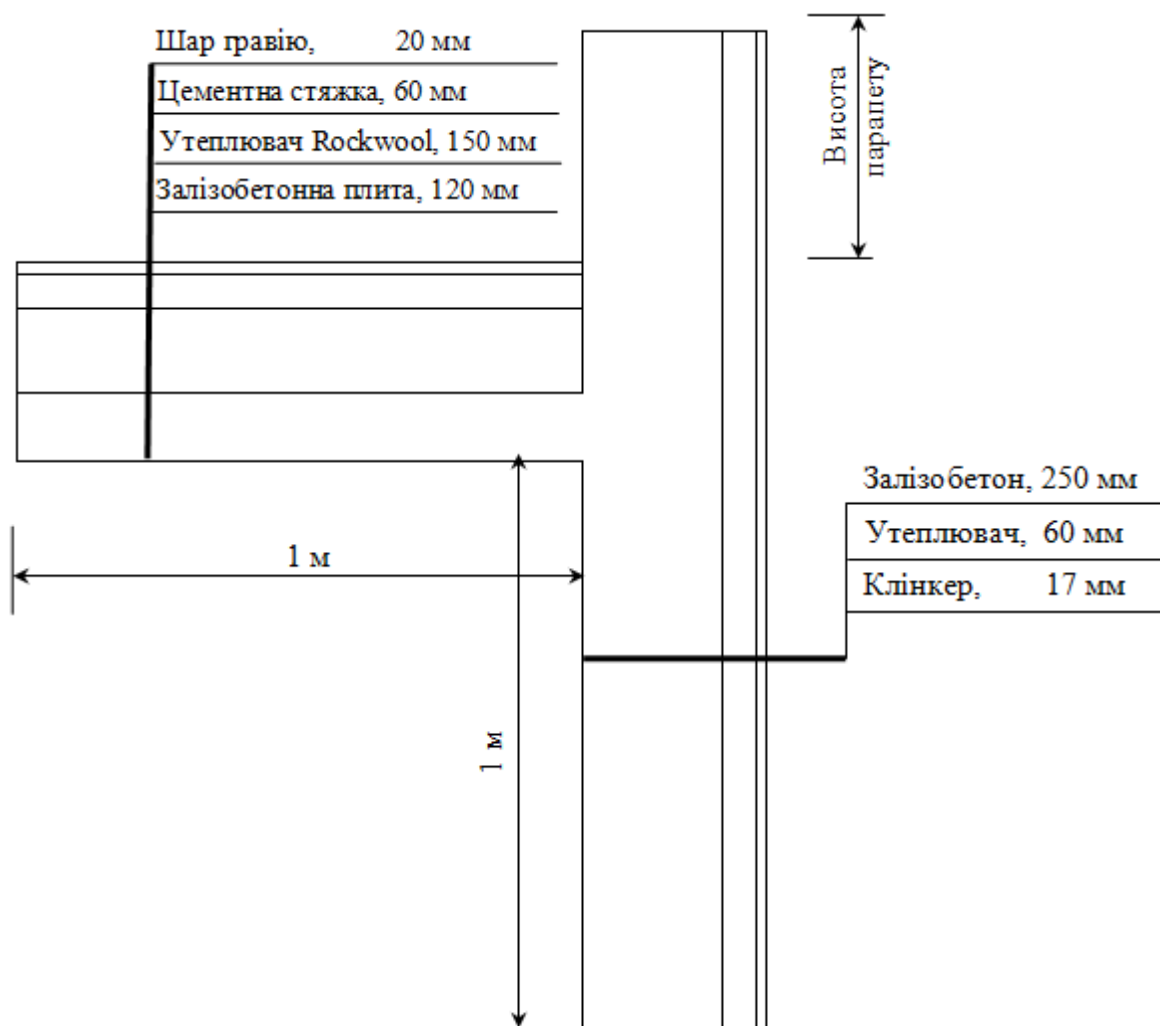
Вузол примикання плити перекриття до стіни сходової клітки
